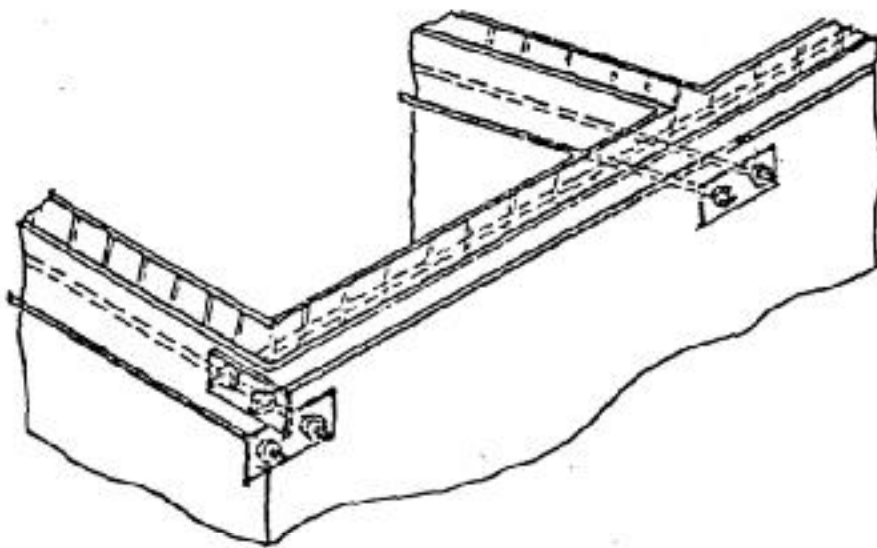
Refuerzo con tirantes de muros de mampostería (ref. 9)
